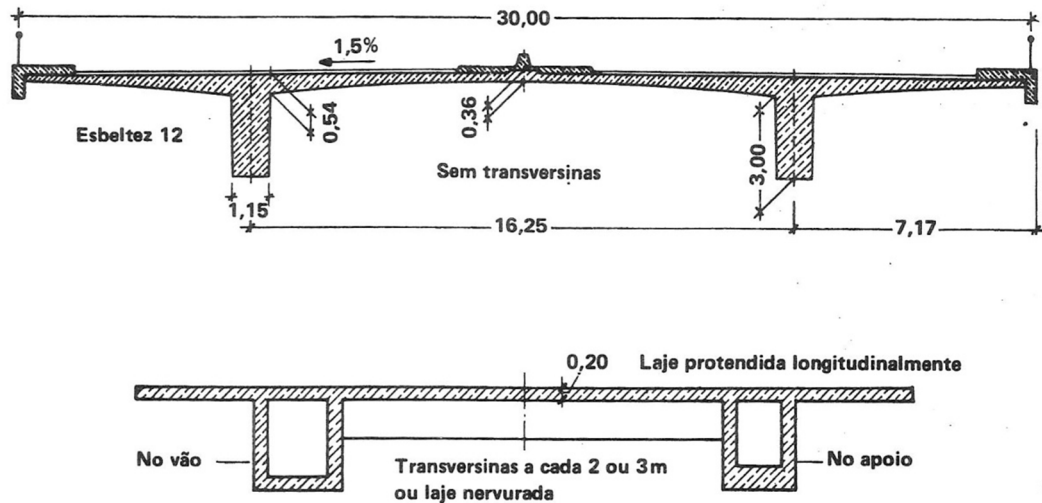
Superestrutura em viga com transversina (LEONHARDT, 1979)
